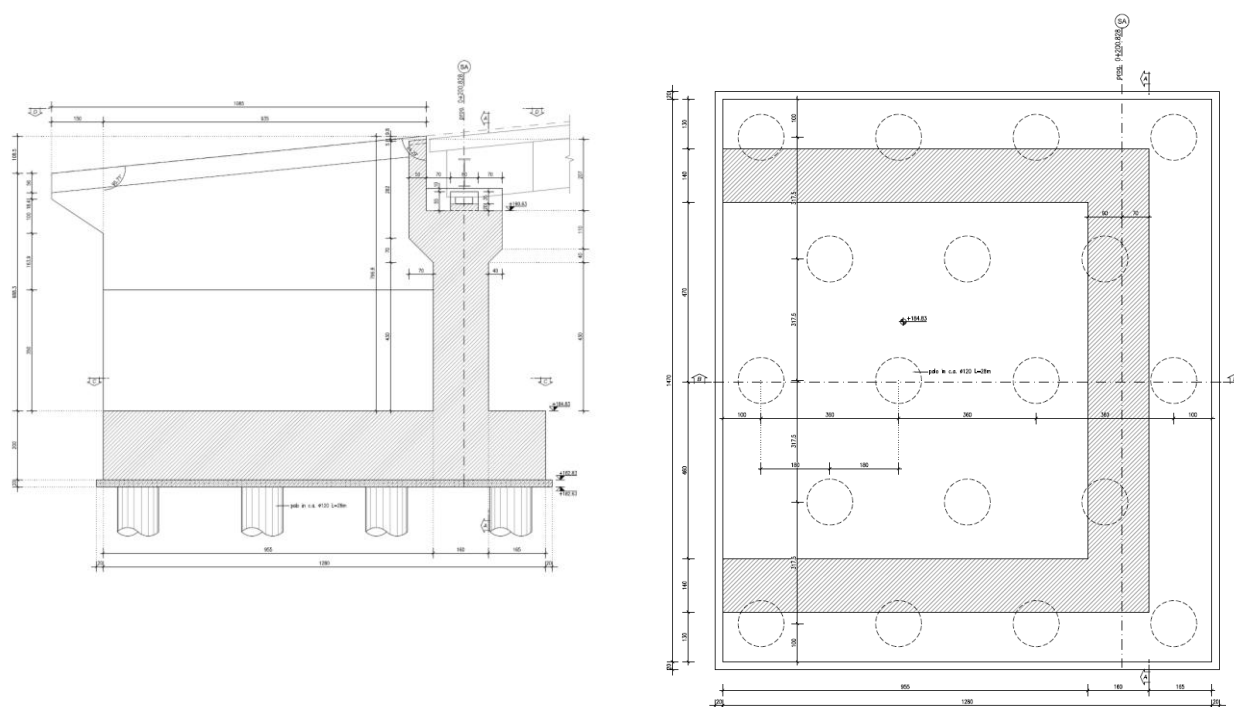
spalla A. sezione trasversale e pianta fondazione
